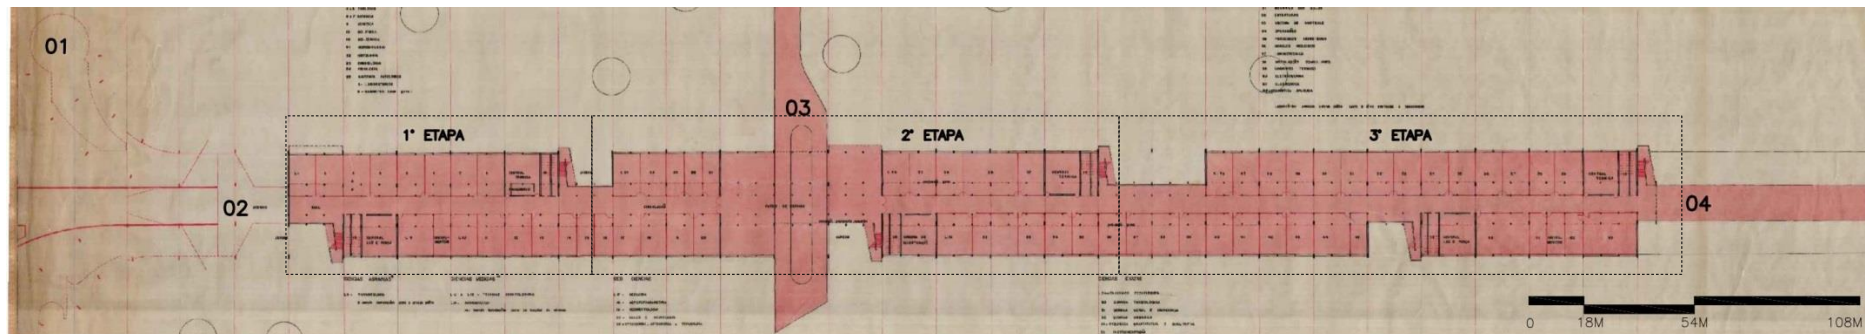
Subsolo Bloco Didático - Plano UMA. Fonte: Prancha 08 do Plano de Implantação Imediata – 1º Sub-Etapa Plano UMA – Arquivo digital disponível no COMCAP-UEM.
